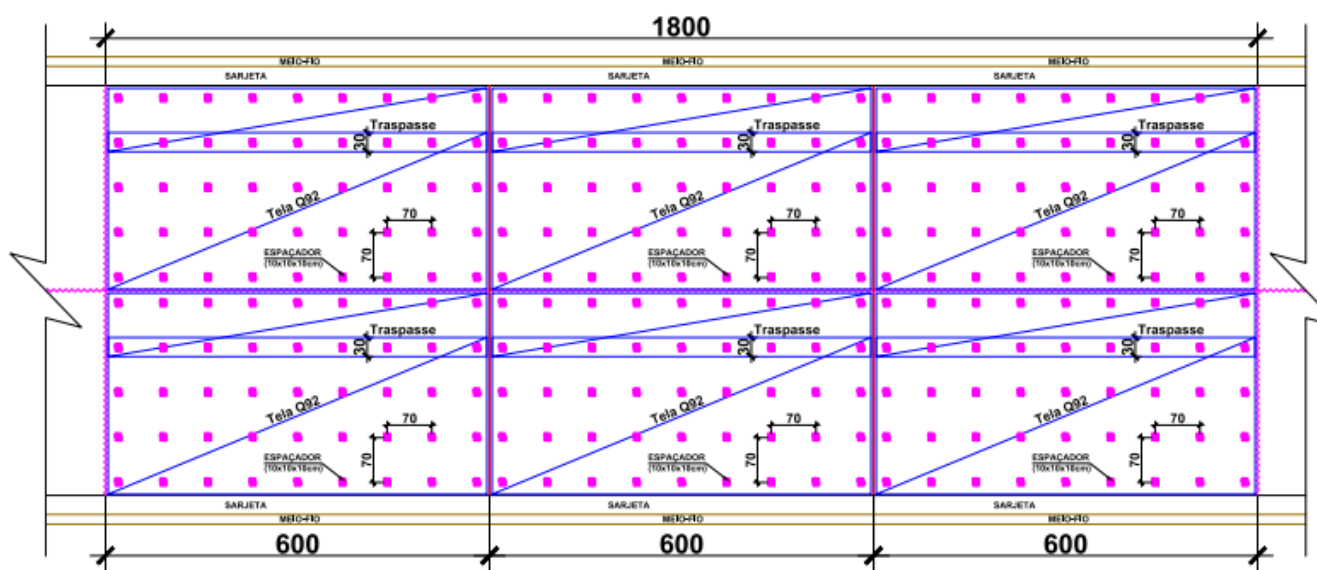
LOCAÇÃO DAS TELAS E DOS ESPAÇADORES TIPO COCADA DO PAVIMENTO RÍGIDO 12 CM
